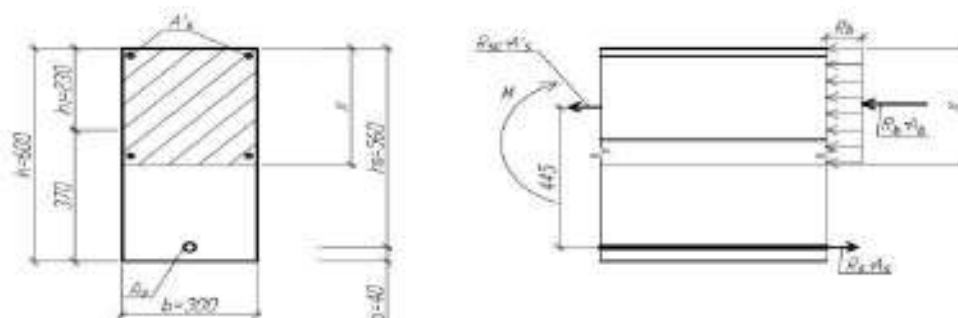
Поперечное прямоугольное сечение изгибаемого железобетонного элемента с рабочей арматурой в верхней зоне
